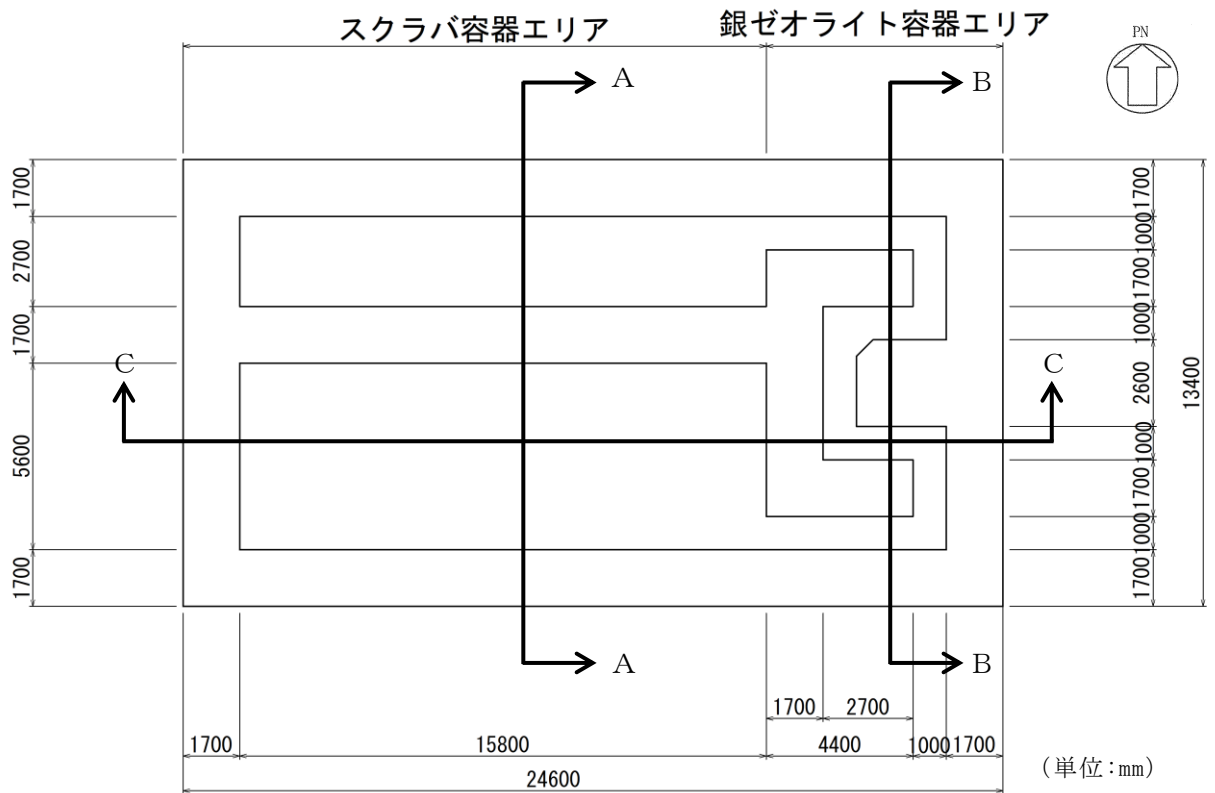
第1ベントフィルタ格納槽 評価対象断面位置図
